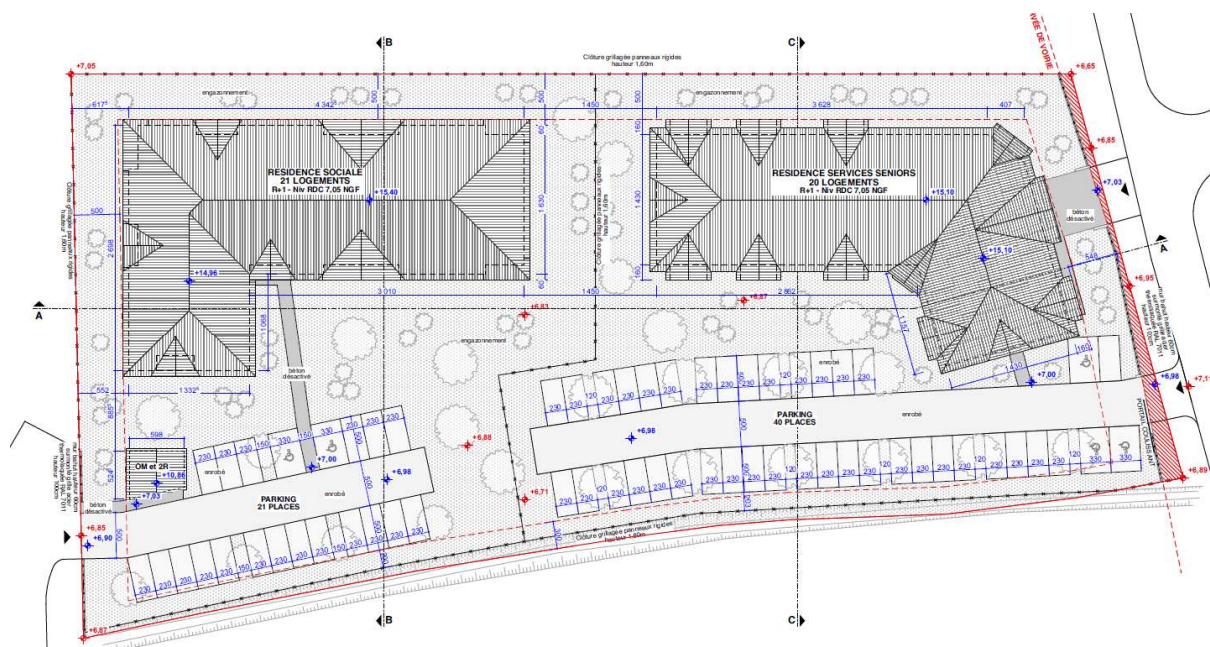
Plan masse du projet (Source : Permis de construire – EVEN BTP)
